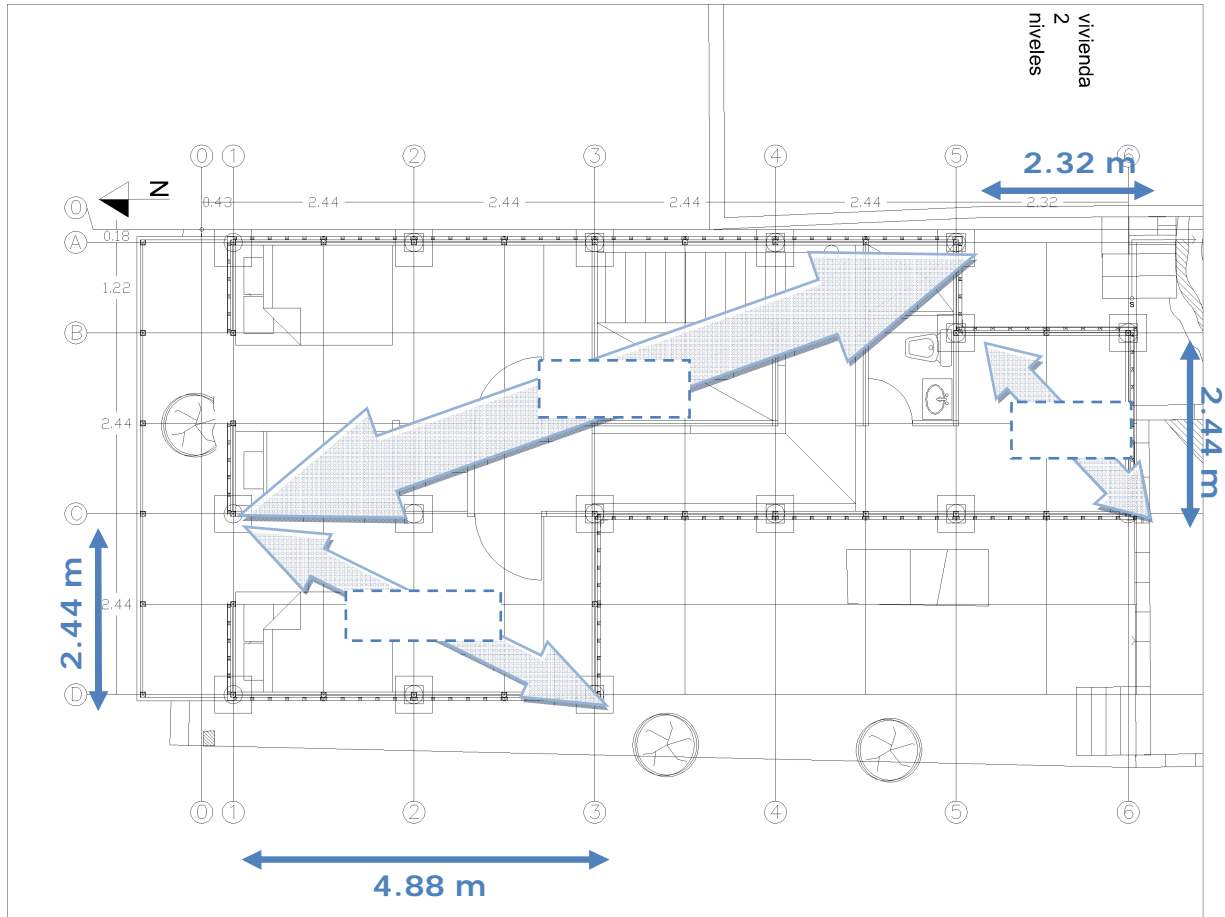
c-2 - Plano de la planta baja de la casa Rosenda [15]
